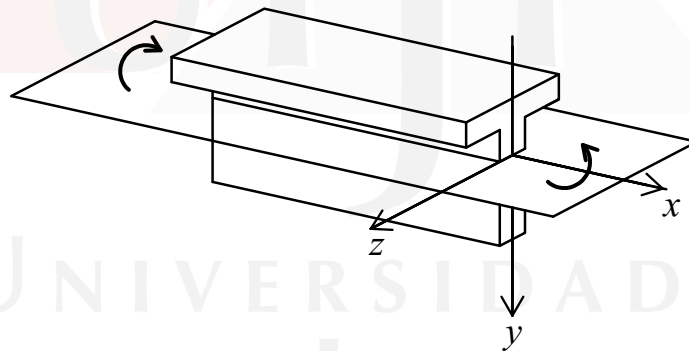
Viga T em flexão reta - Plano de Solicitação horizontal
